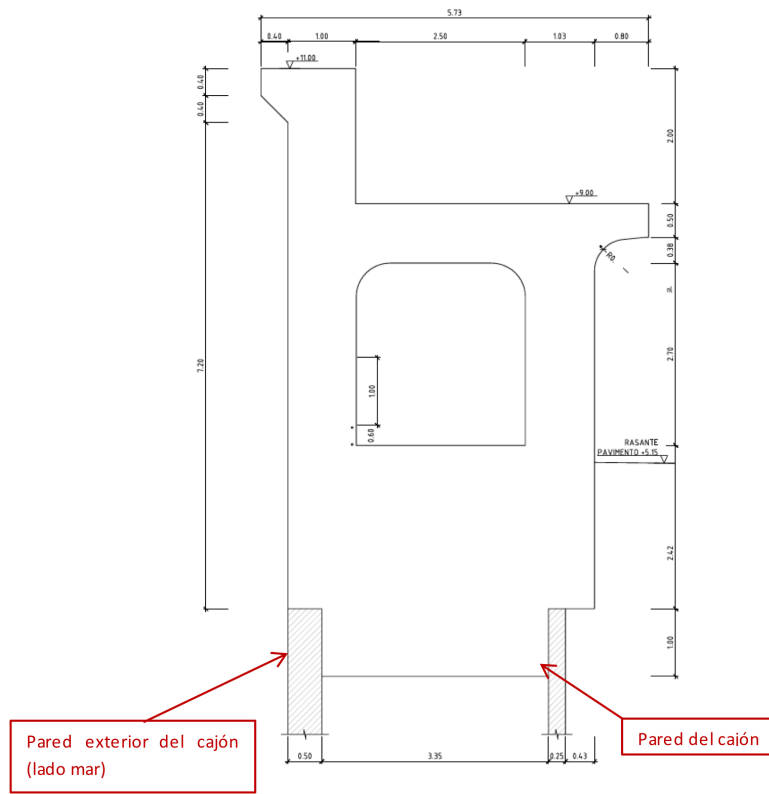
Espaldón de hormigón armado, con galería central. Sección tipo geometría y armado
